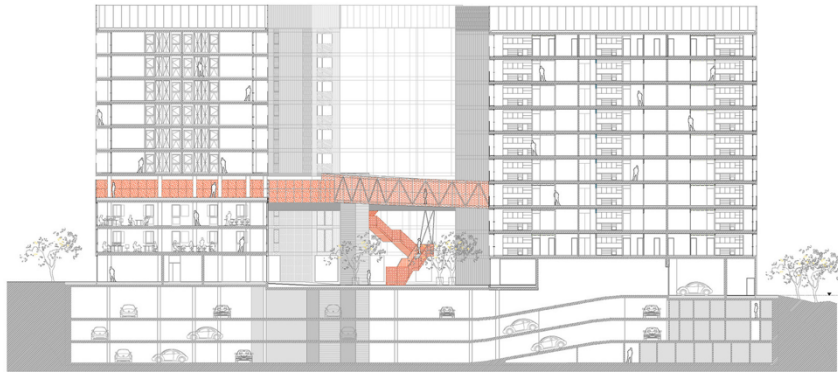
Sección donde se aprecia la disposición de la plaza y la escalera colgada.
